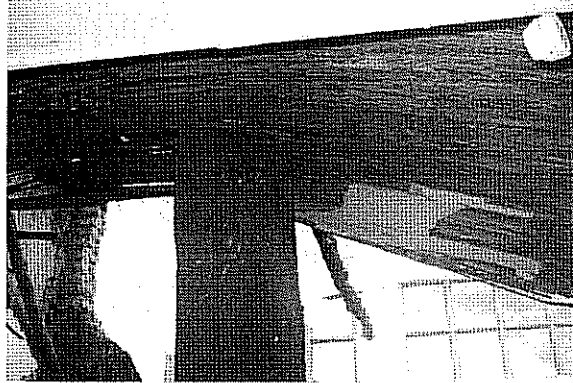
Cielo raso en mal estado, edificación del costado sur.
